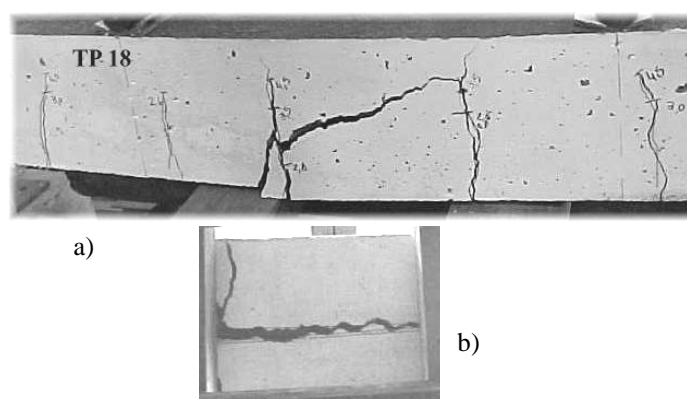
Viga *TP18* – a) vista lateral - b) vista da ruptura de fundo.
